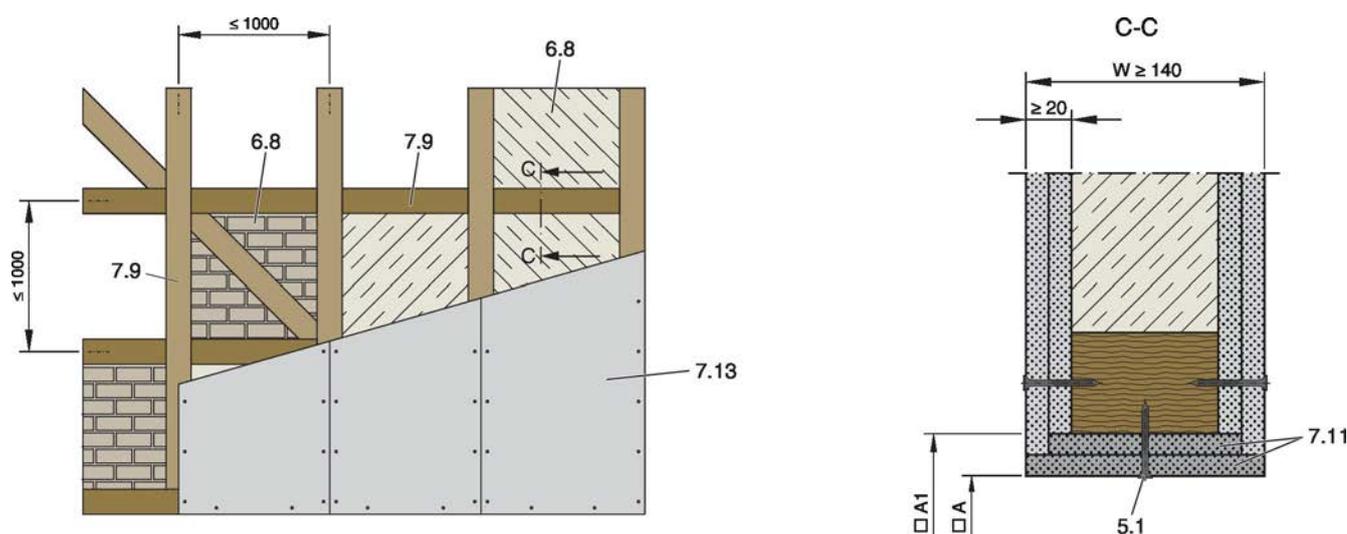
Parede divisória leve, estrutura em enxaimel com revestimento de ambos os lados
